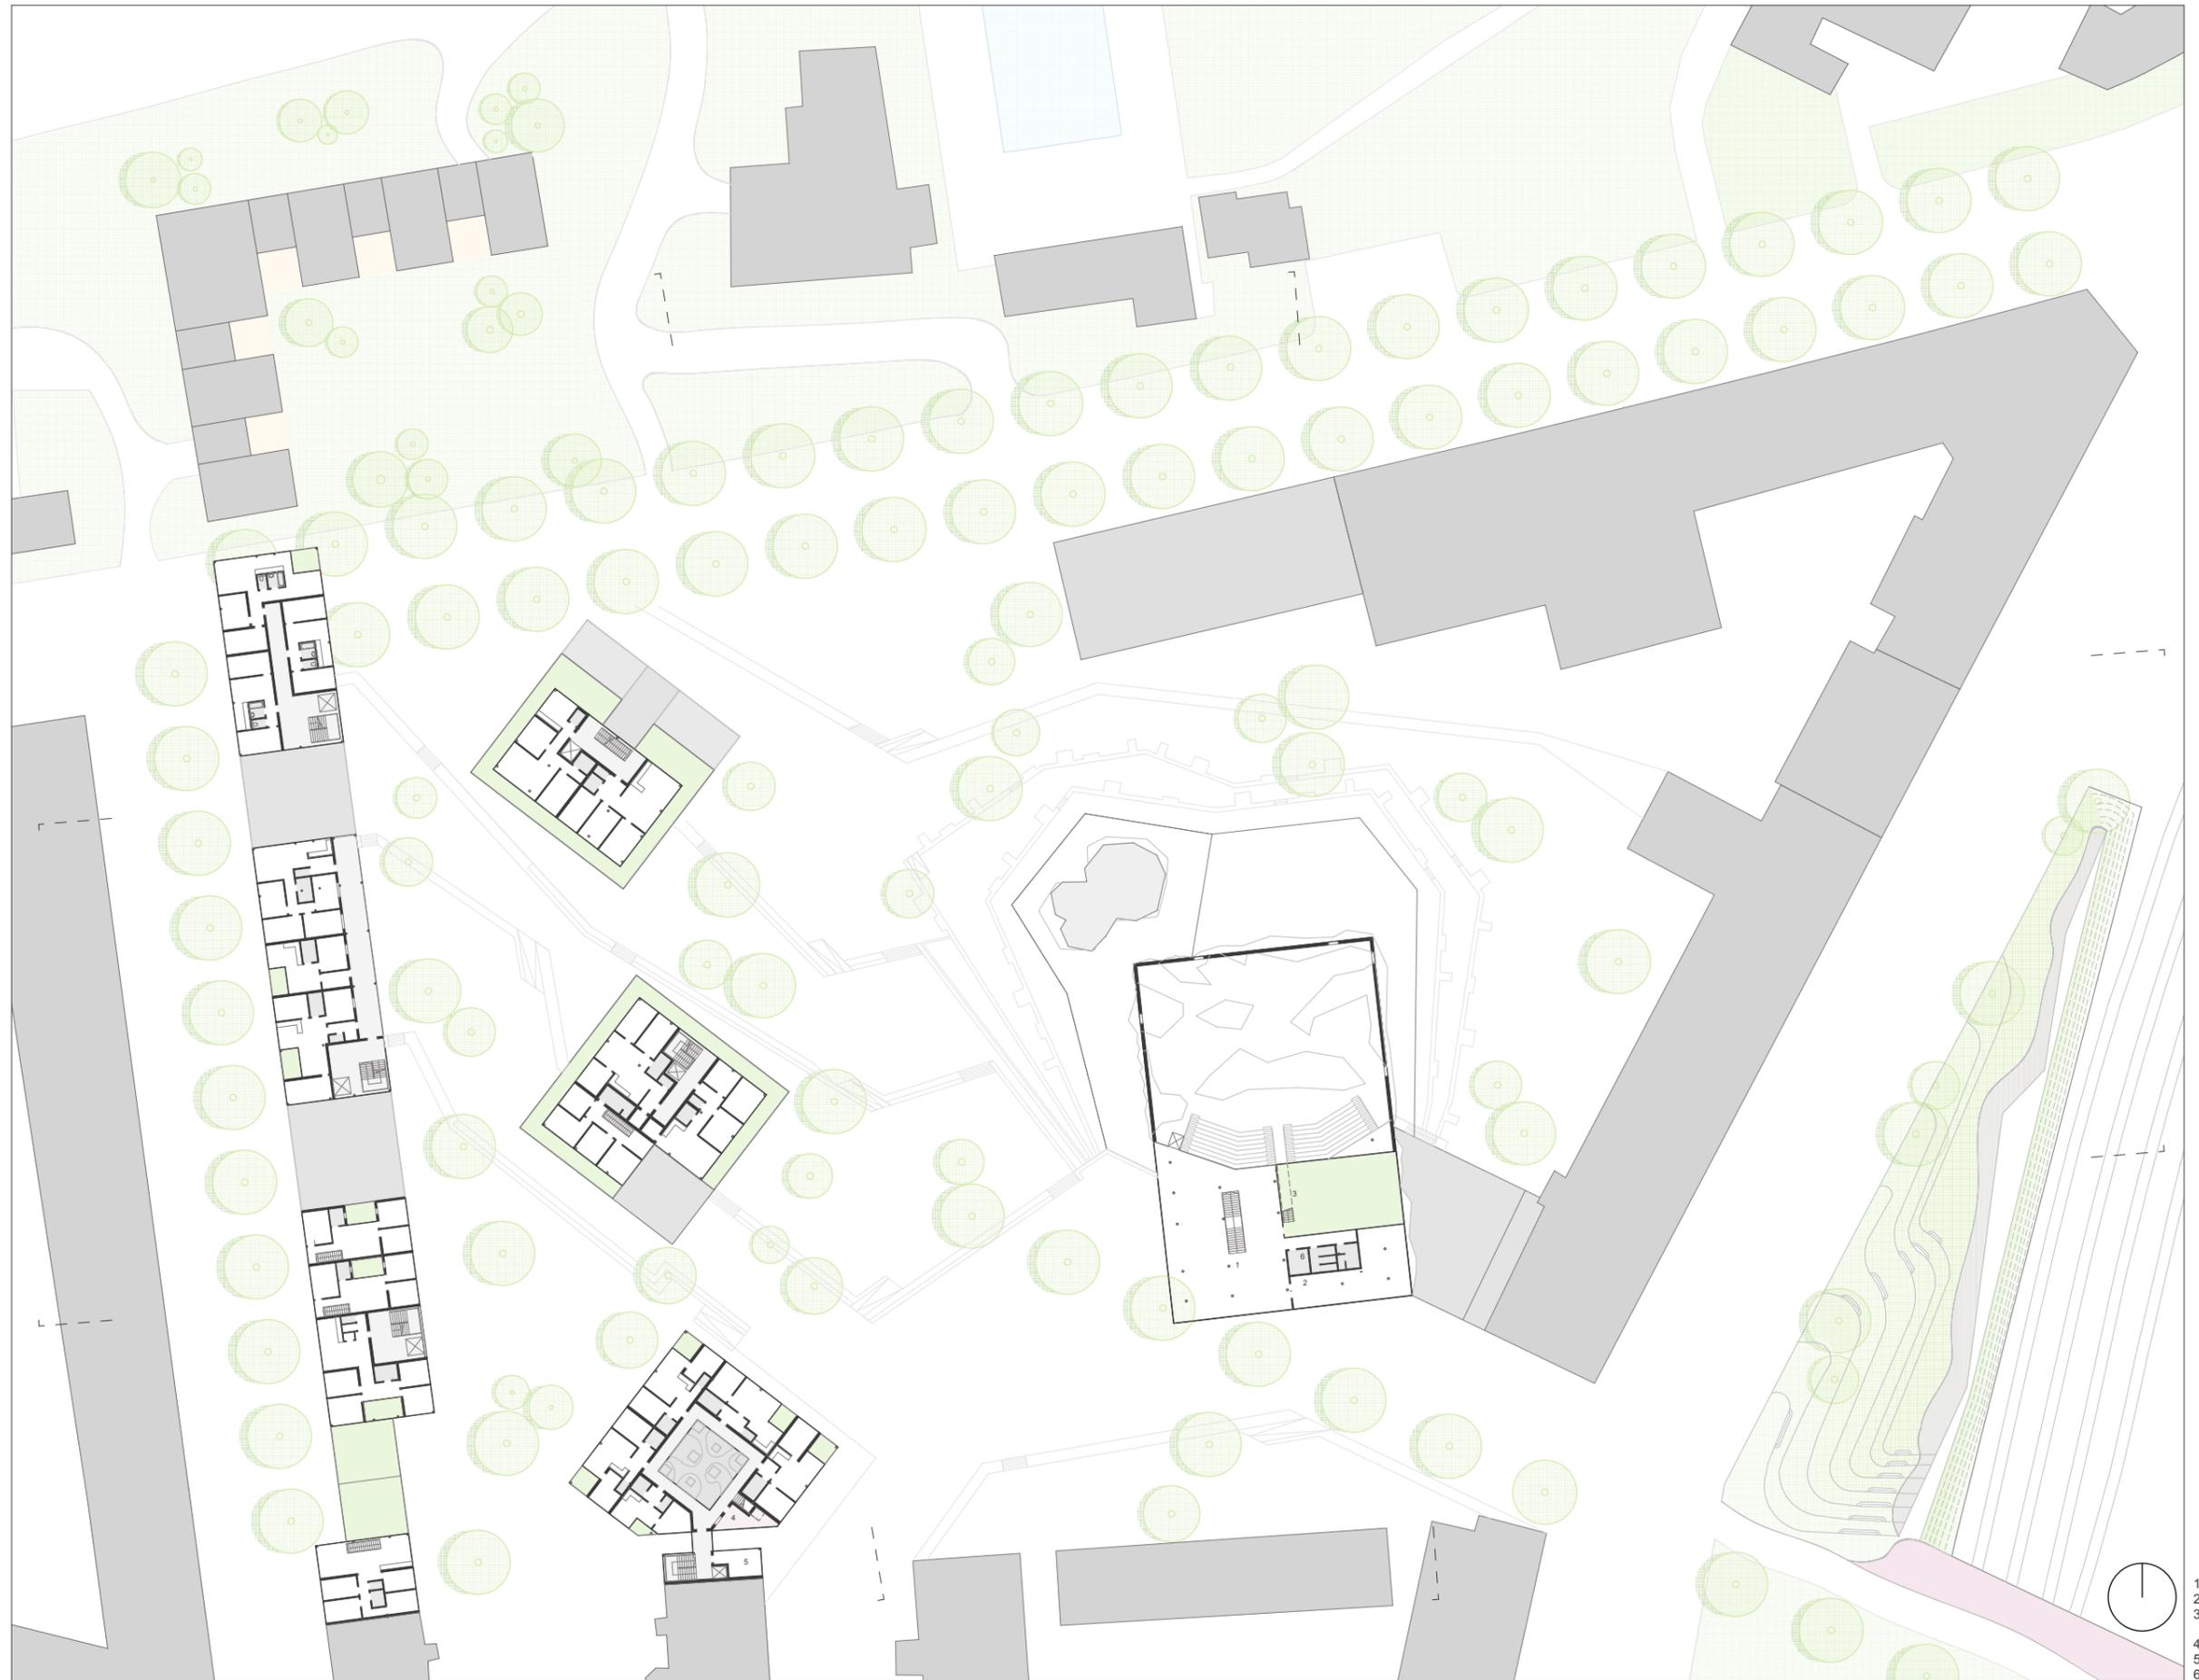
Grundriss des vierten Obergeschosses
